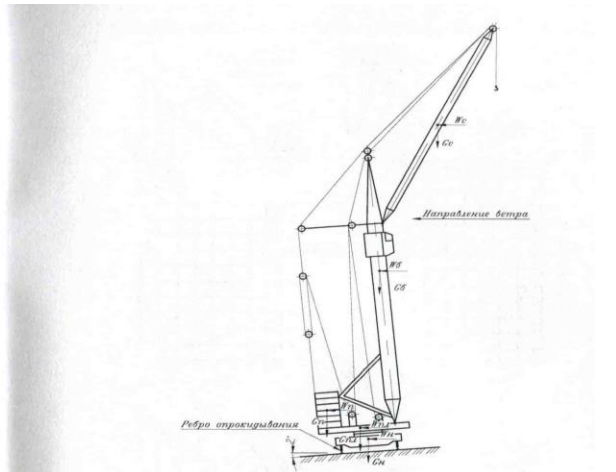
Расчетная схема собственной устойчивости башенного крана
